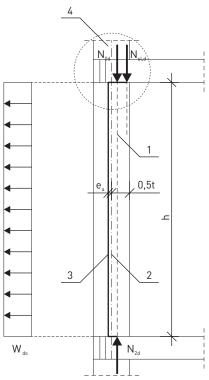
Расчетная схема наружной стены из блоков YTONG
